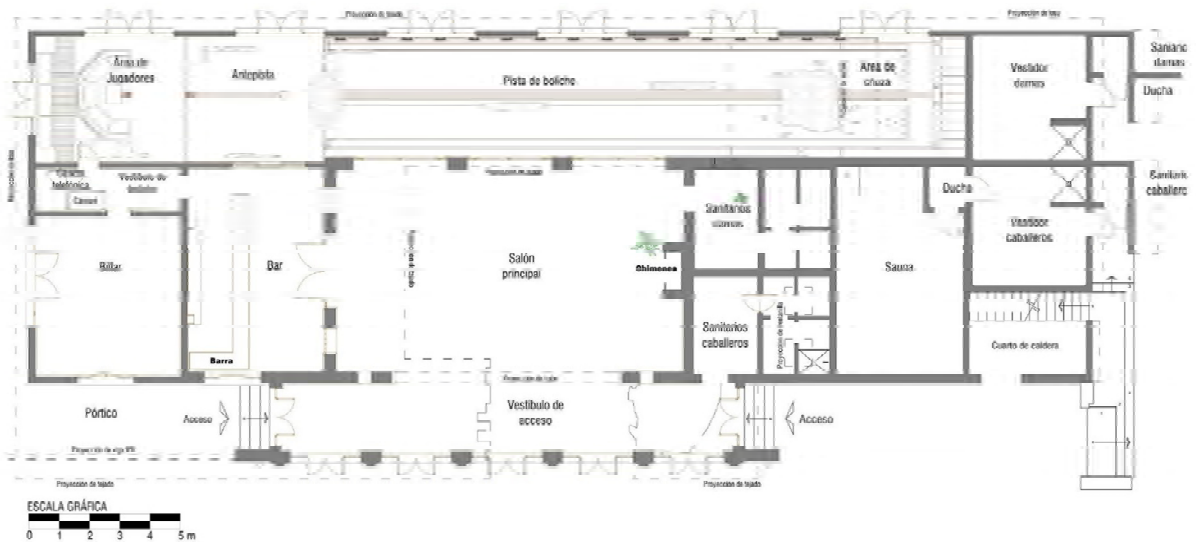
Estado actual de la planta baja. EPG 2014.
